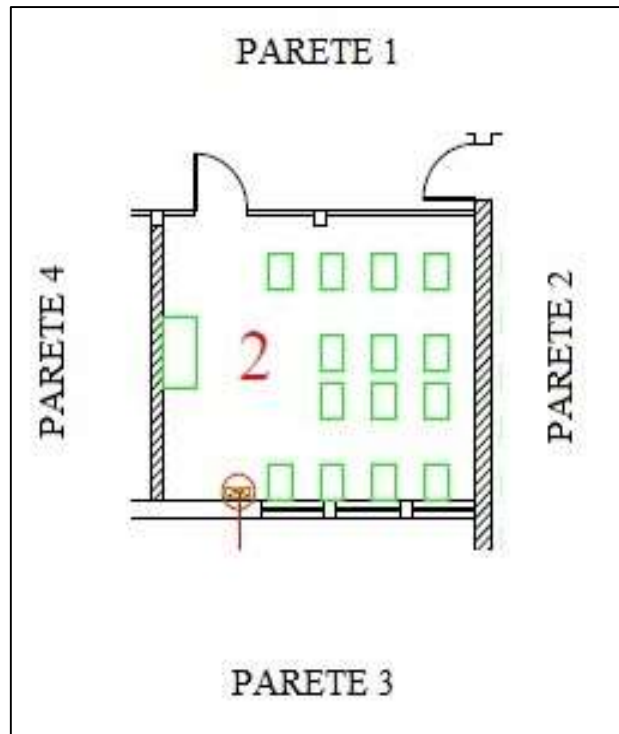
Planimetria dell'Aula 2 (3°A) oggetto di misurazioni
